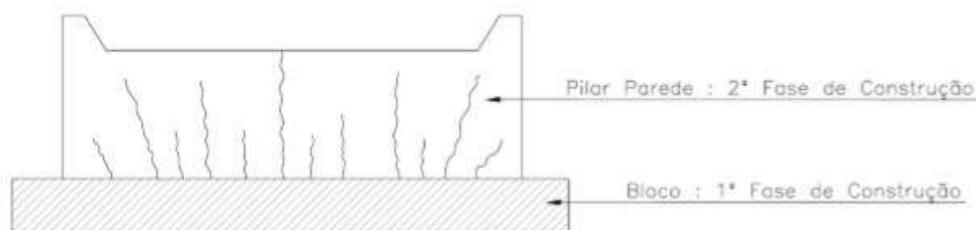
Fissura típica de retração plástica do concreto
